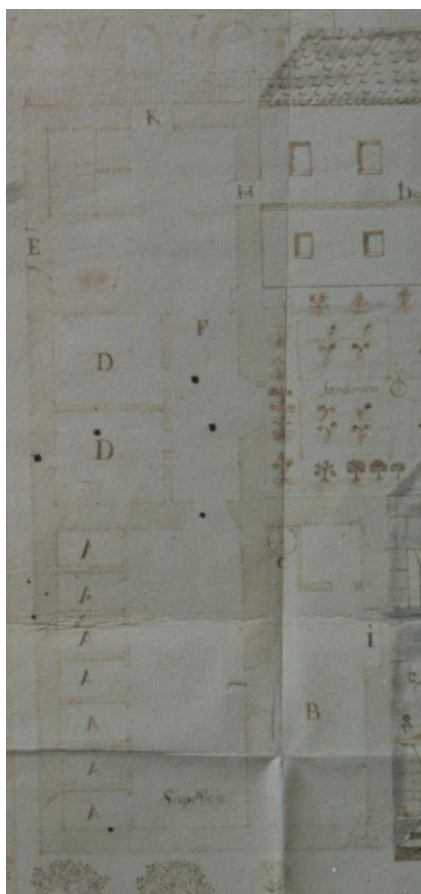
JUAN ANTONIO CAMACHO. *Descripción del plano sexto...* Planta de la enfermería (detalle). Fuente:
